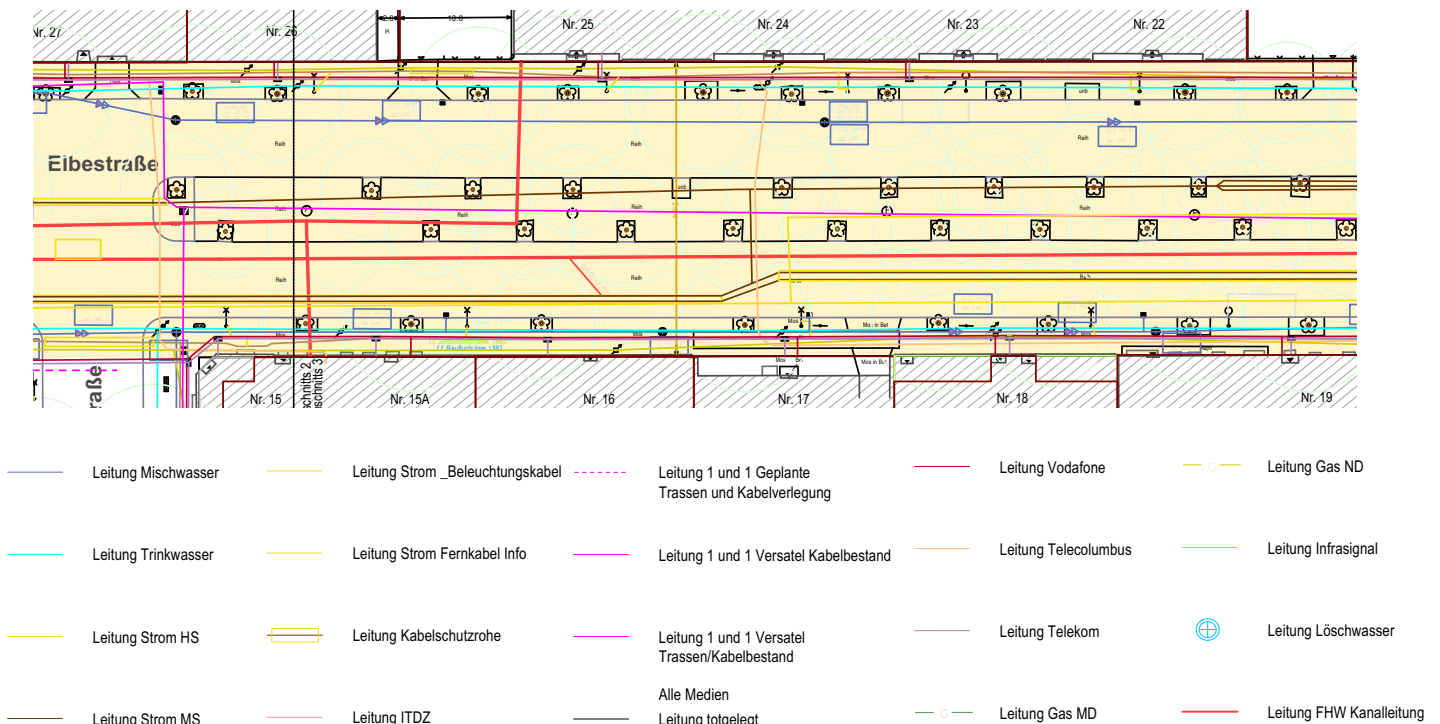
Ausschnitt Leitungsplan Höhe Schandauer Str.
